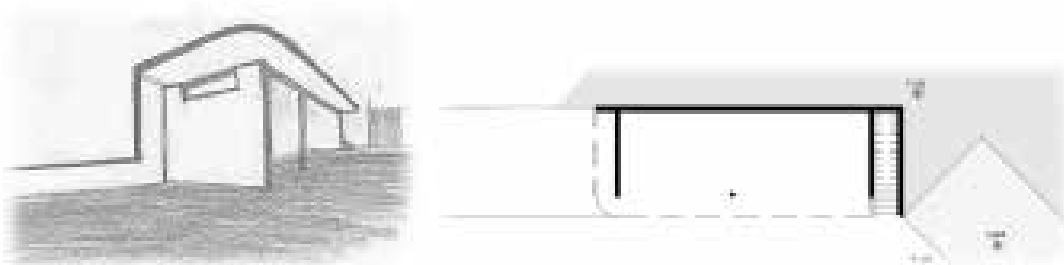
Esboço e Planta do Telheiro. (Ilustração nossa, 2017).
